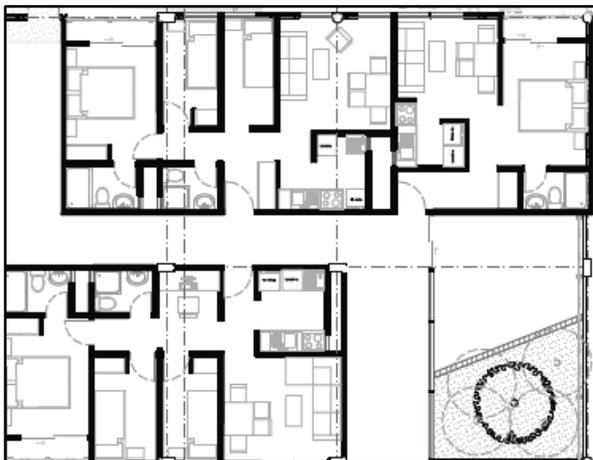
Apartamentos tipos del proyecto de vivienda en altura. Elaboración propia.
